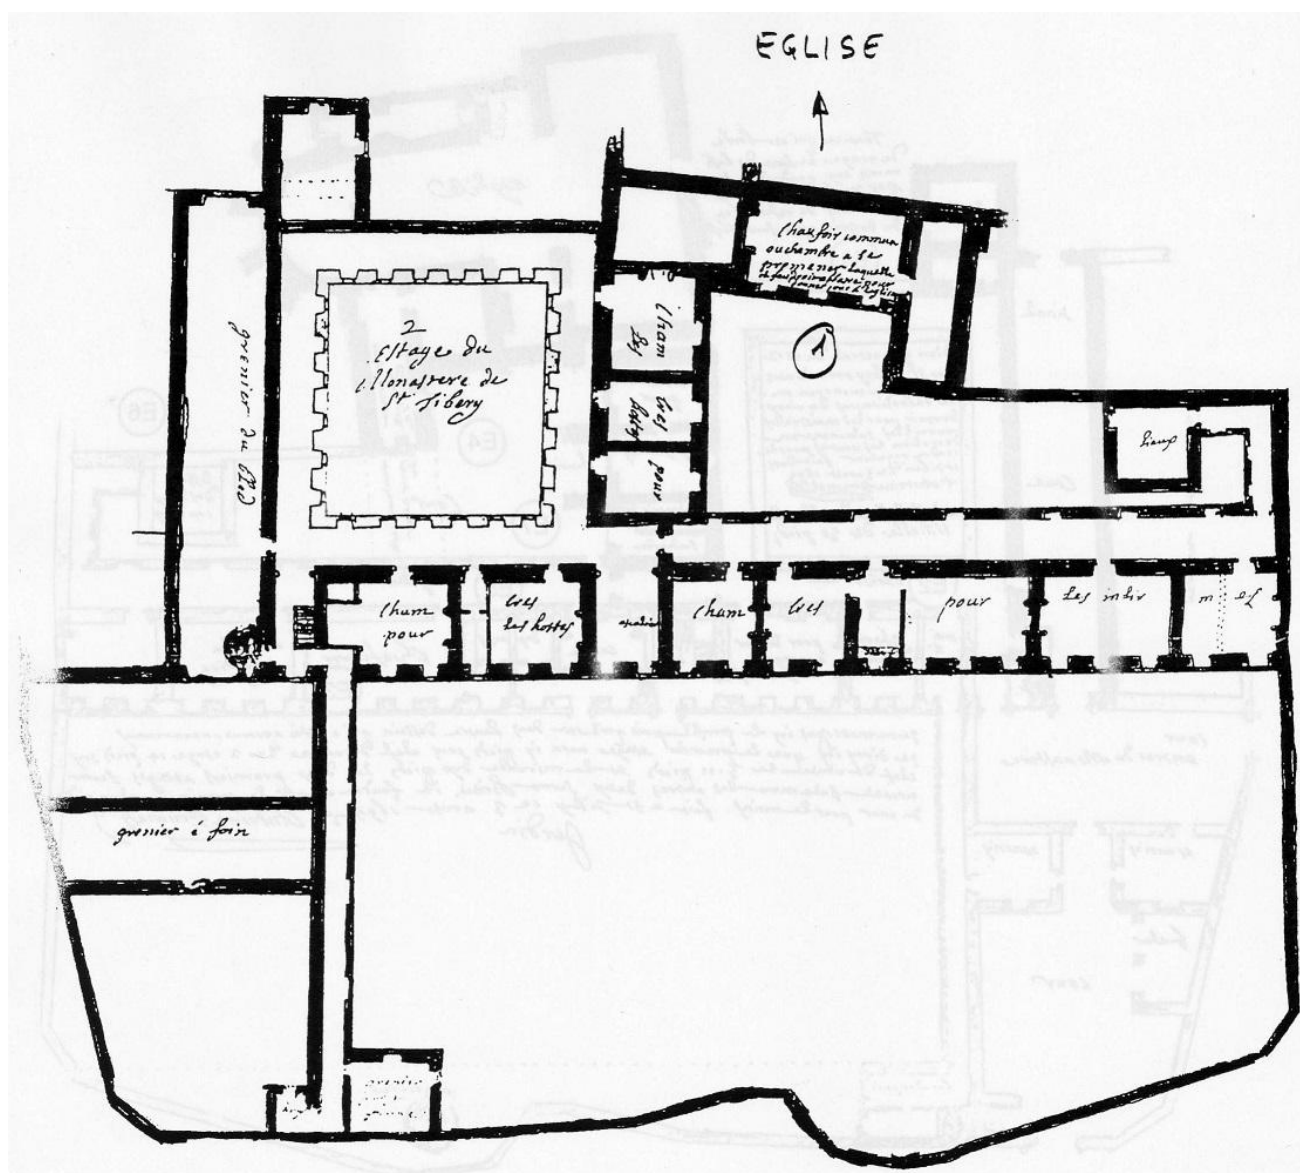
Plan F. Le projet de 1695 : plan du premier étage.
